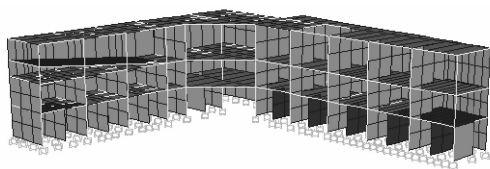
结构负三层增设钢筋混凝土剪力墙局部模型
